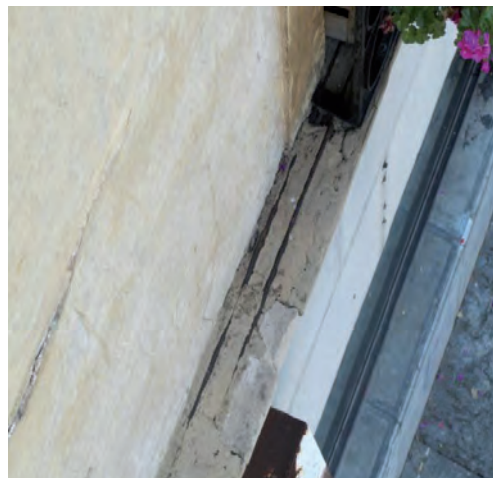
46. CORNISA DE HORMIGÓN ARMADO EN FACHADA A PLAZA BERRI CON ARMADURAS CORROIDAS
